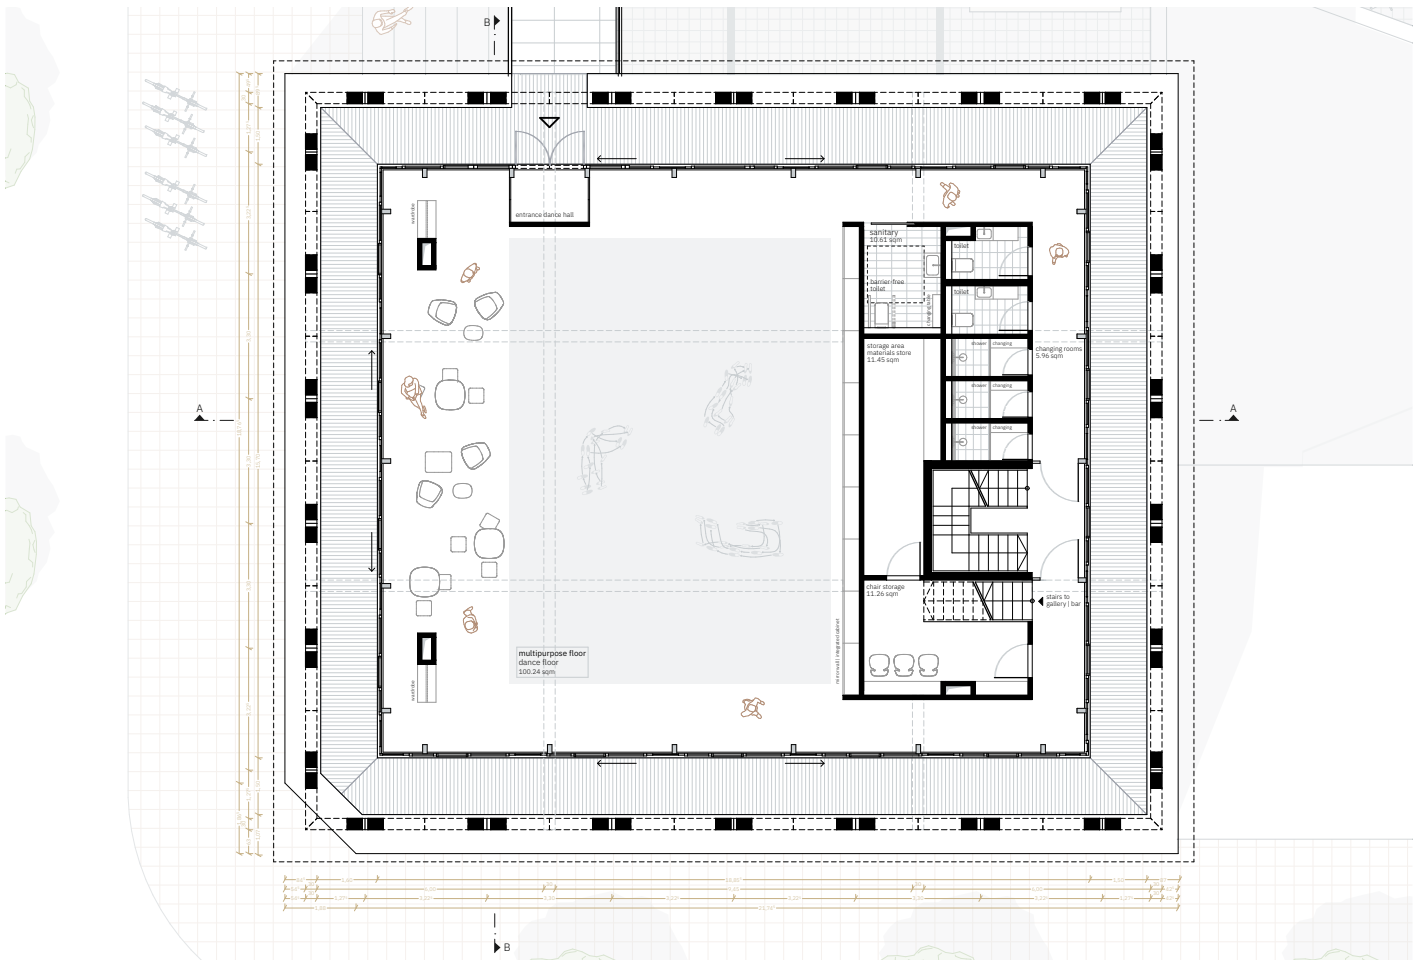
2. Obergeschoss | Urban Gap, M 1:200
